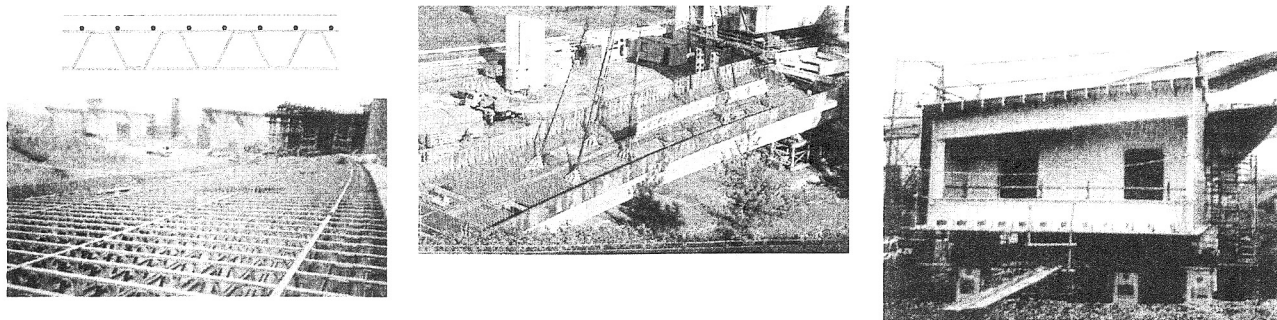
合成床版の施工事例 I：箱桁橋への適用（大ブロック架設の例）
